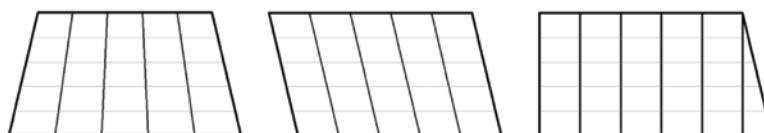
Posibles distribuciones de las vigas y consecuente geometría de los casetones.
